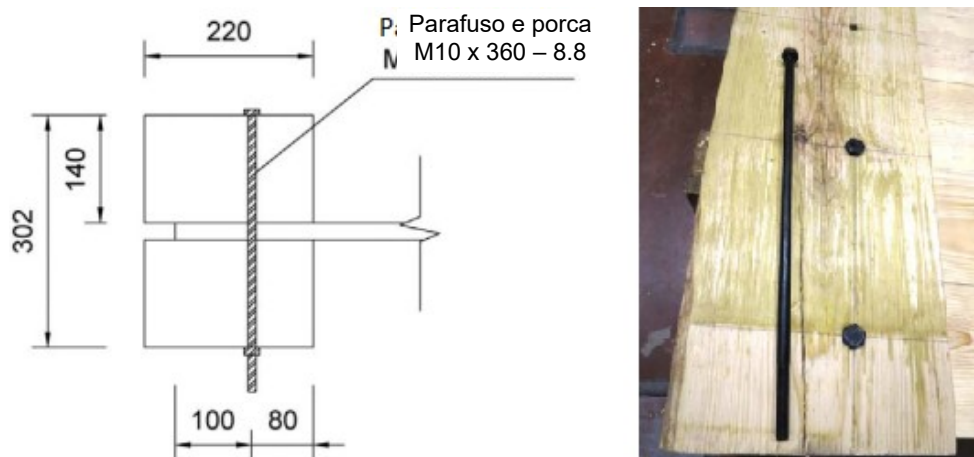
Esquema das ligações com as vigas de bordo. (Dimensões em mm) (Fragomeli, 2015)
